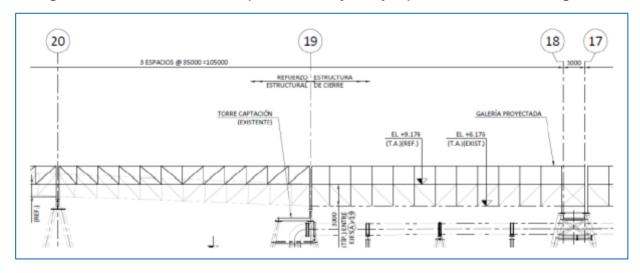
Estructura de cierre (detalle entre ejes 18 y 20) de la reubicación de la galería
